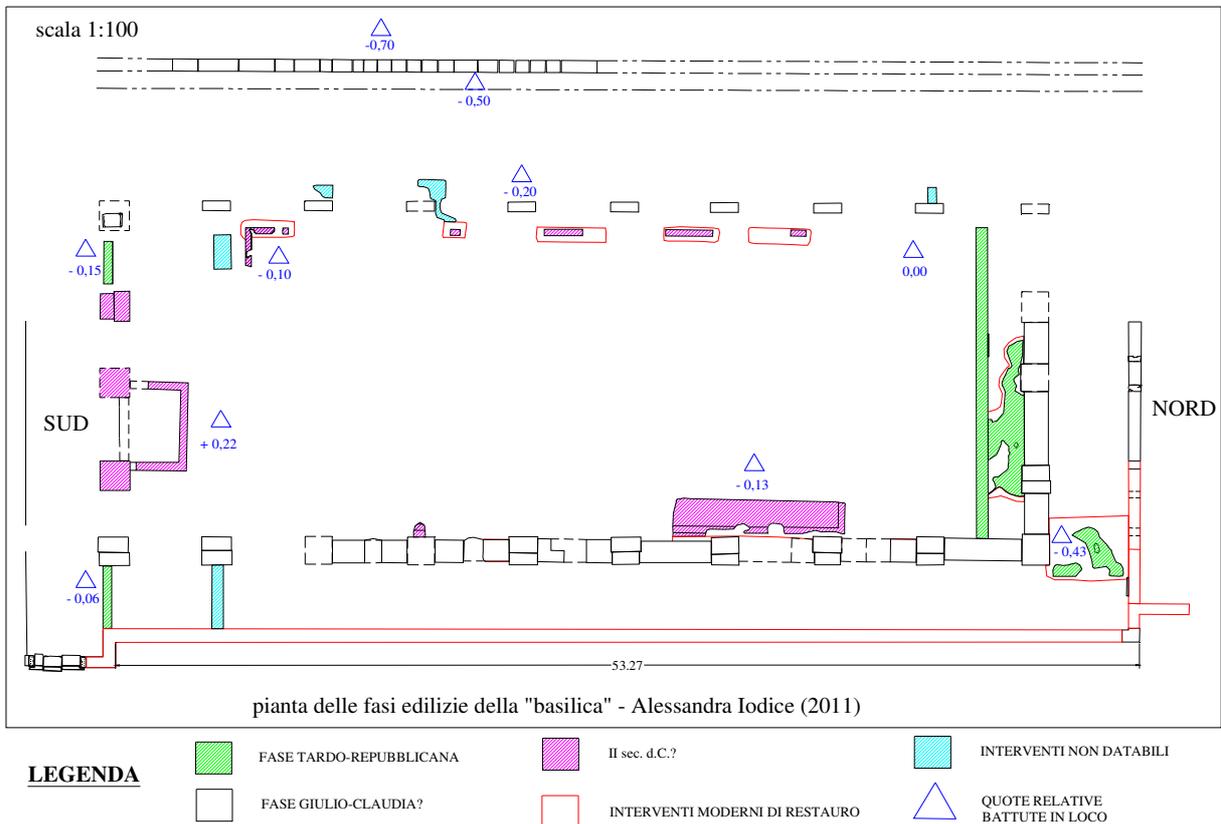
pianta delle fasi edilizie, di Alessandra Iodice.
